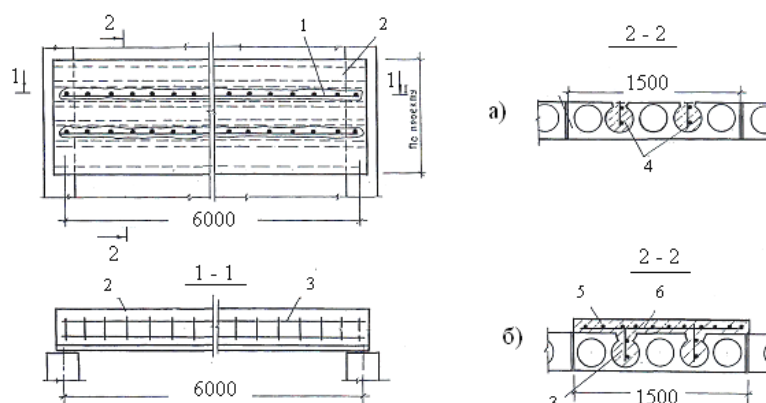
Усиление многопустотных плит перекрытия замоноличиванием каналов пустот: *а – вариант заполнения пустот; б – вариант с применением набетонки; 1, 3 – вновь устанавливаемый арматурный каркас по расчету; 2 – усиливаемая плита; 4 – бетон; 5 – набетонка; 6 – арматурная сетка
